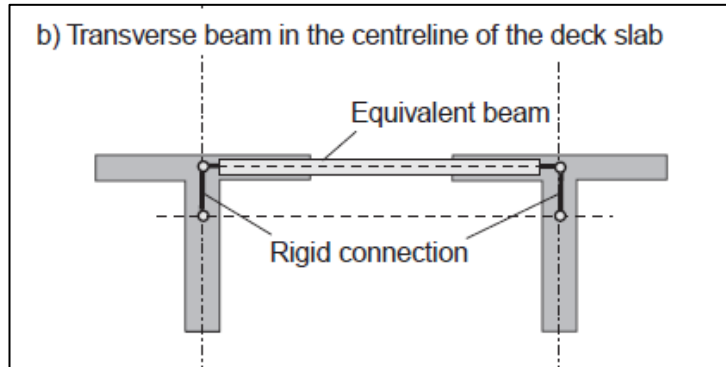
Beam end offset en vigas transversales según el estudio realizado por G.A. Rombach .
